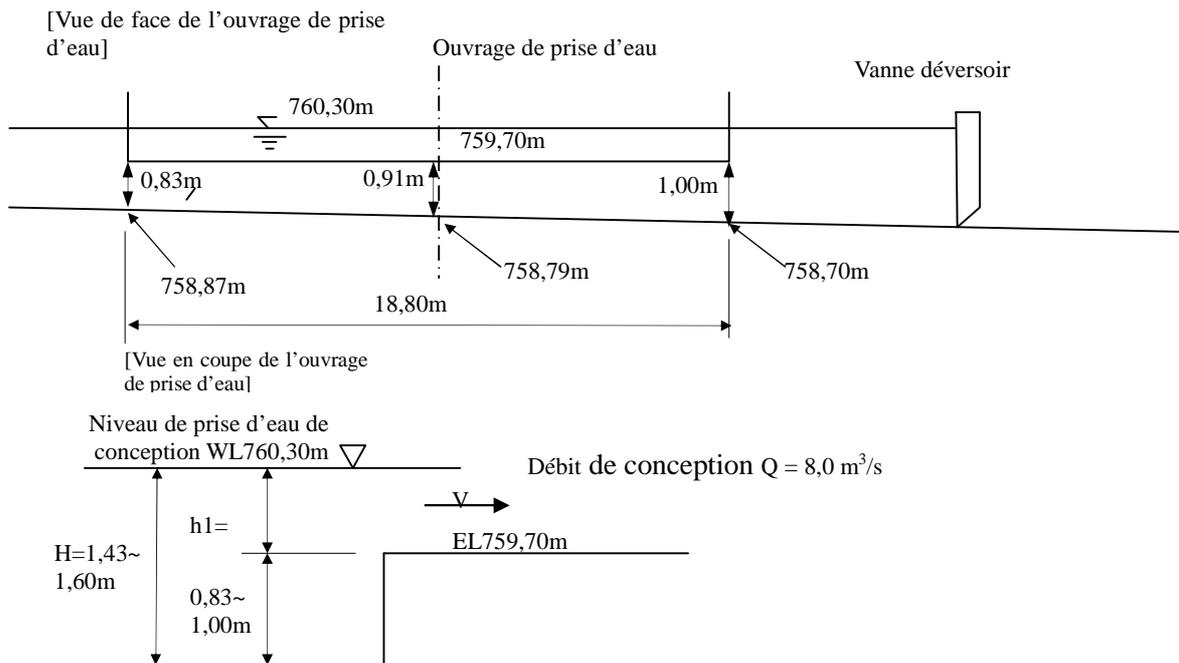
Hauteur de fondation à la prise d'eau de la tête de prise P5
